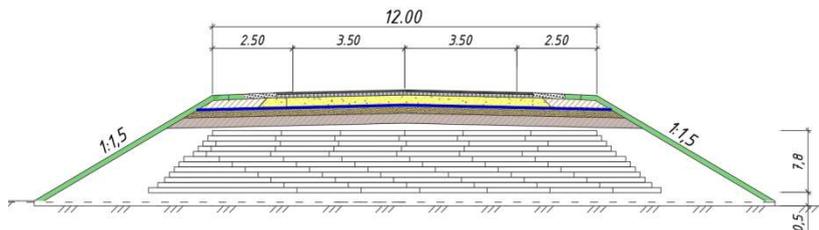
Поперечный профиль легкой насыпи из пенополистирольных блоков
